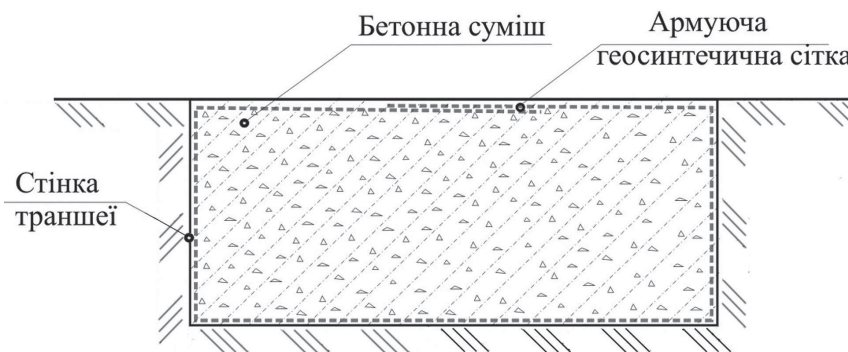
Конструкція фундаментної подушки з бетону та армуючою сіткою з геосинтетичного матеріалу
